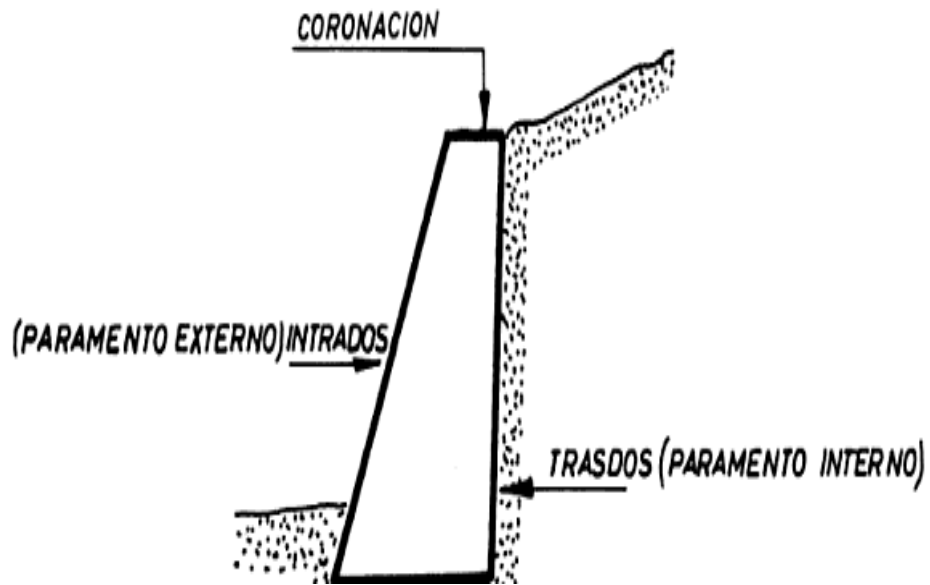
Muro de concreto en masa (Barros; 1947:13)
